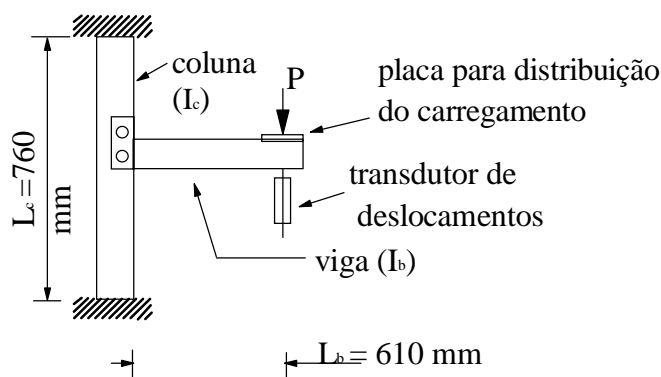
Esquema do ensaio da viga em balanço (*Cantilever test*) segundo as prescrições do RMI.
